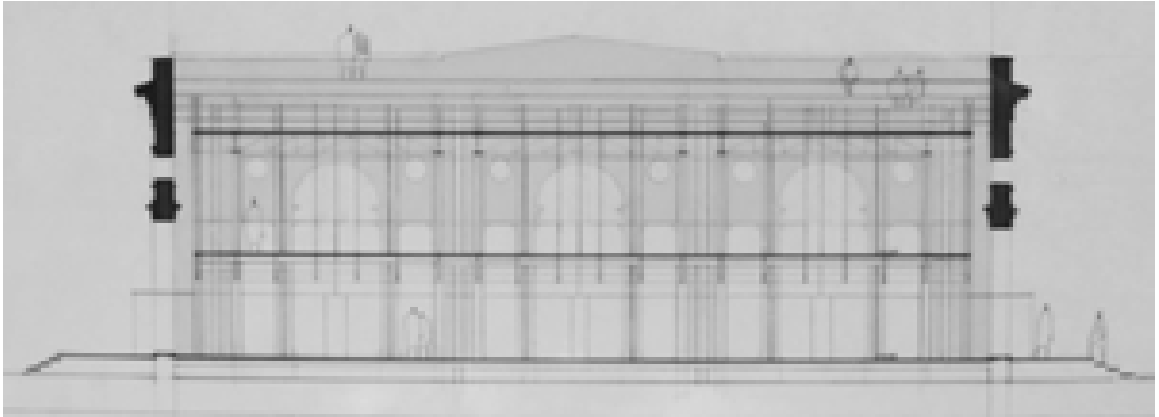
Sezione longitudinale CD allegata al plastico del progetto definitivo (AABS-927)
